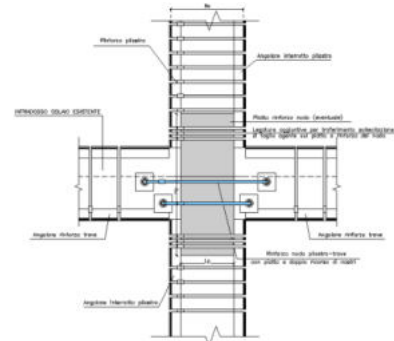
Particolare tipologico: Sistema CAM® applicata al nodo trave-pilastro in facciata, prospetto.
